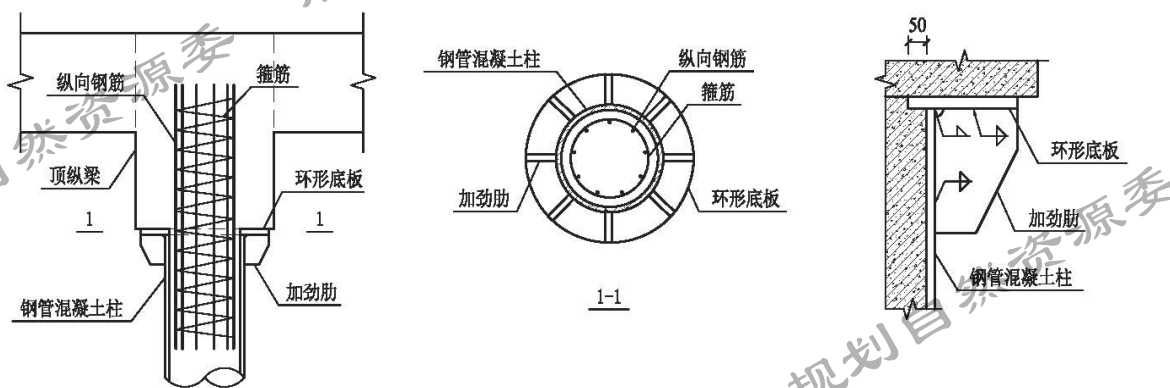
钢管混凝土柱与顶纵梁端承式连接节点示意
